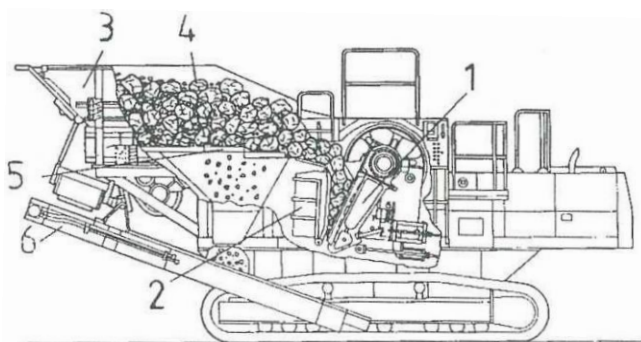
Recyklační souprava [2 – str. 290]
